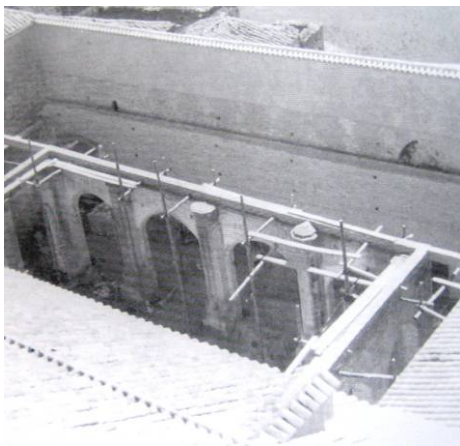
Obras de restauración del claustro de la Catedral. Se ve el muro construido delante de las capillas para apoyo del forjado. AFVM.
